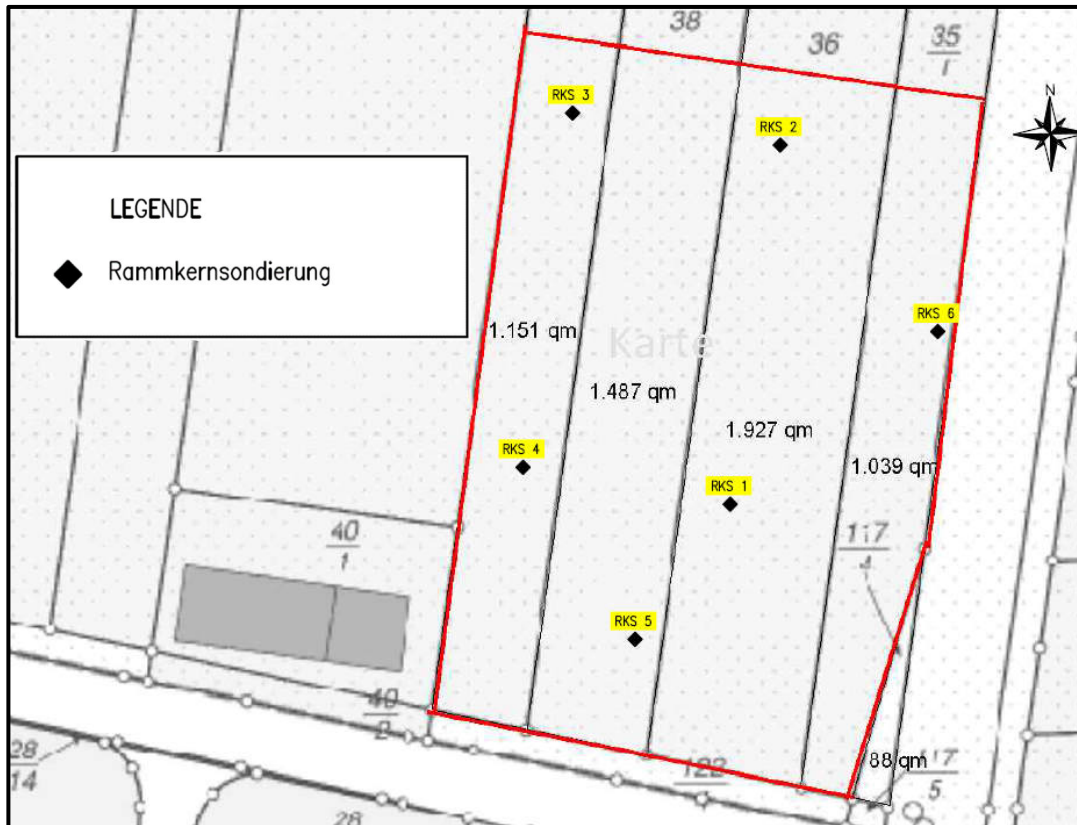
Lageplan mit Eintragung der Bohrpunkte
